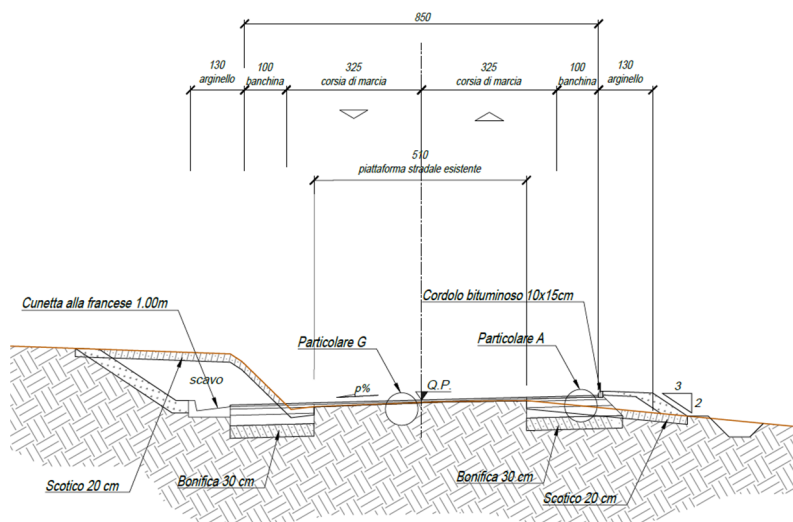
Adeguamento di via Cà Lillina – Sezione tipo - Progetto Esecutivo
